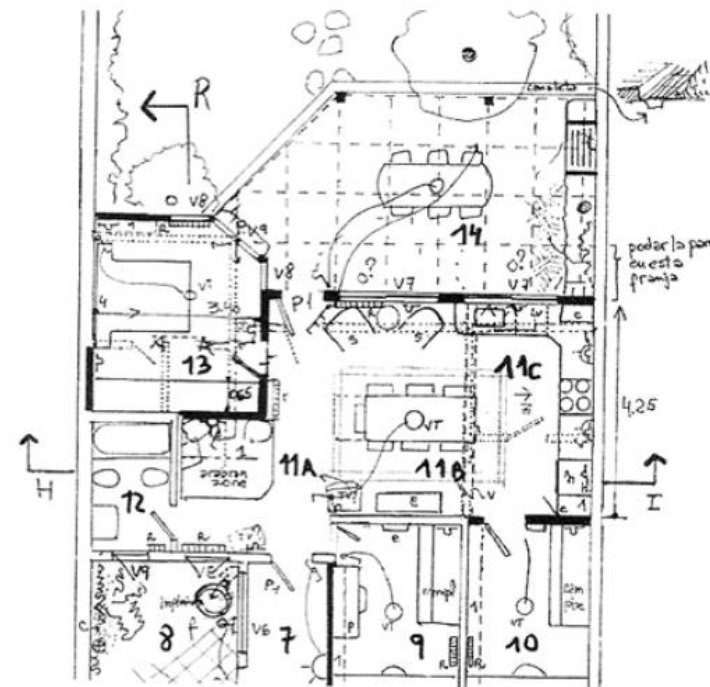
Manual de Instruções elaborado por Livingston.
